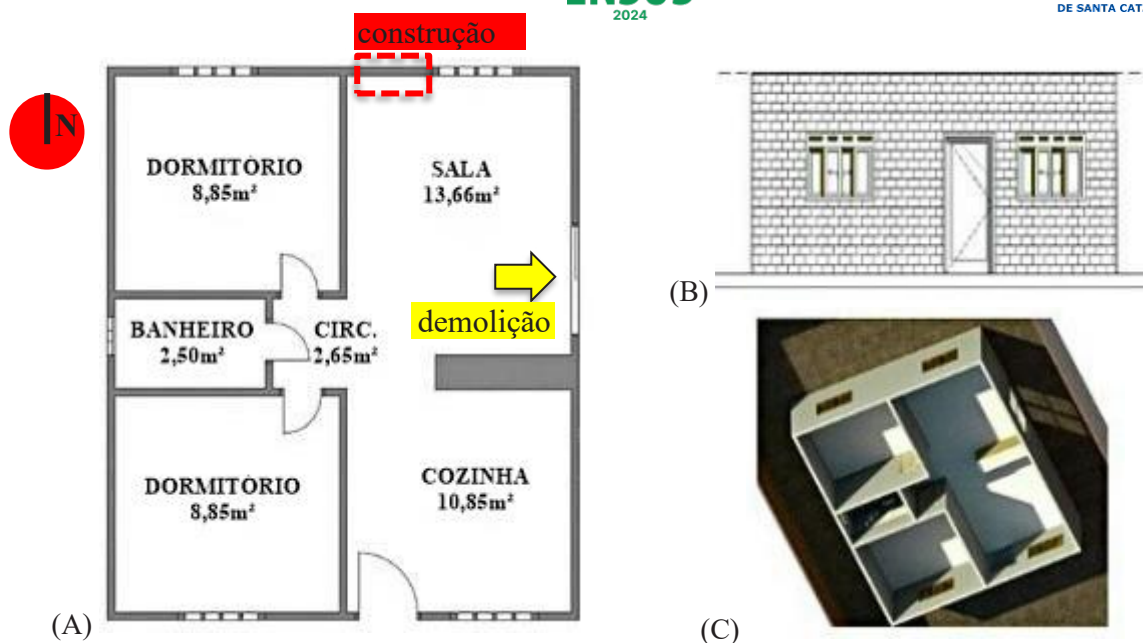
Projeto habitacional: (A) Planta baixa adaptada de acordo com as modificações de novas aberturas realizadas pelo morador, na planta original o acesso principal constava com 0,60 m, conforme delimitado com marcação vermelha tracejada, sendo substituída por vãos maiores, destacado com seta amarela; (B) Elevação, blocos de tijolos cerâmicos; (C) Perspectiva Interna. Fonte: elaborado pelos autores.
